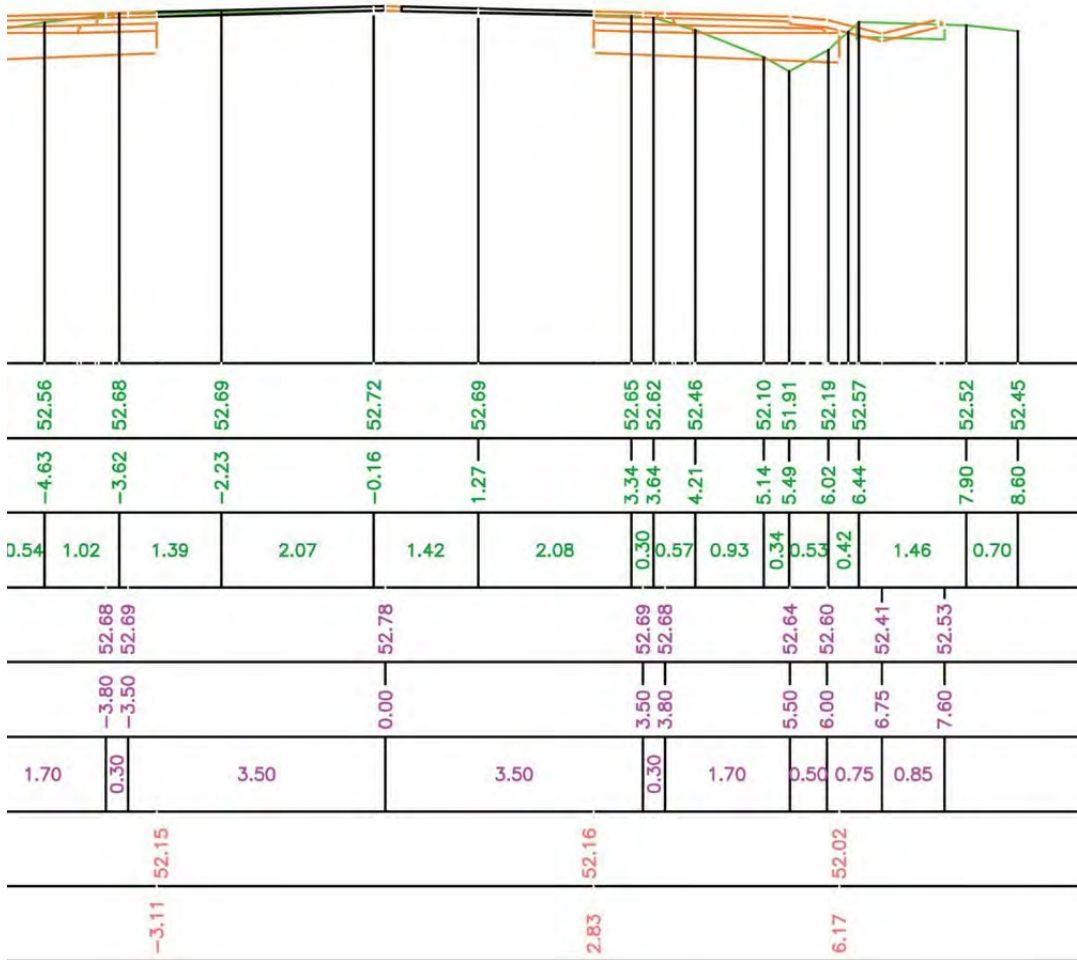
Profil en travers particulier - Exemple en section courante. (Voir p.62-63)
